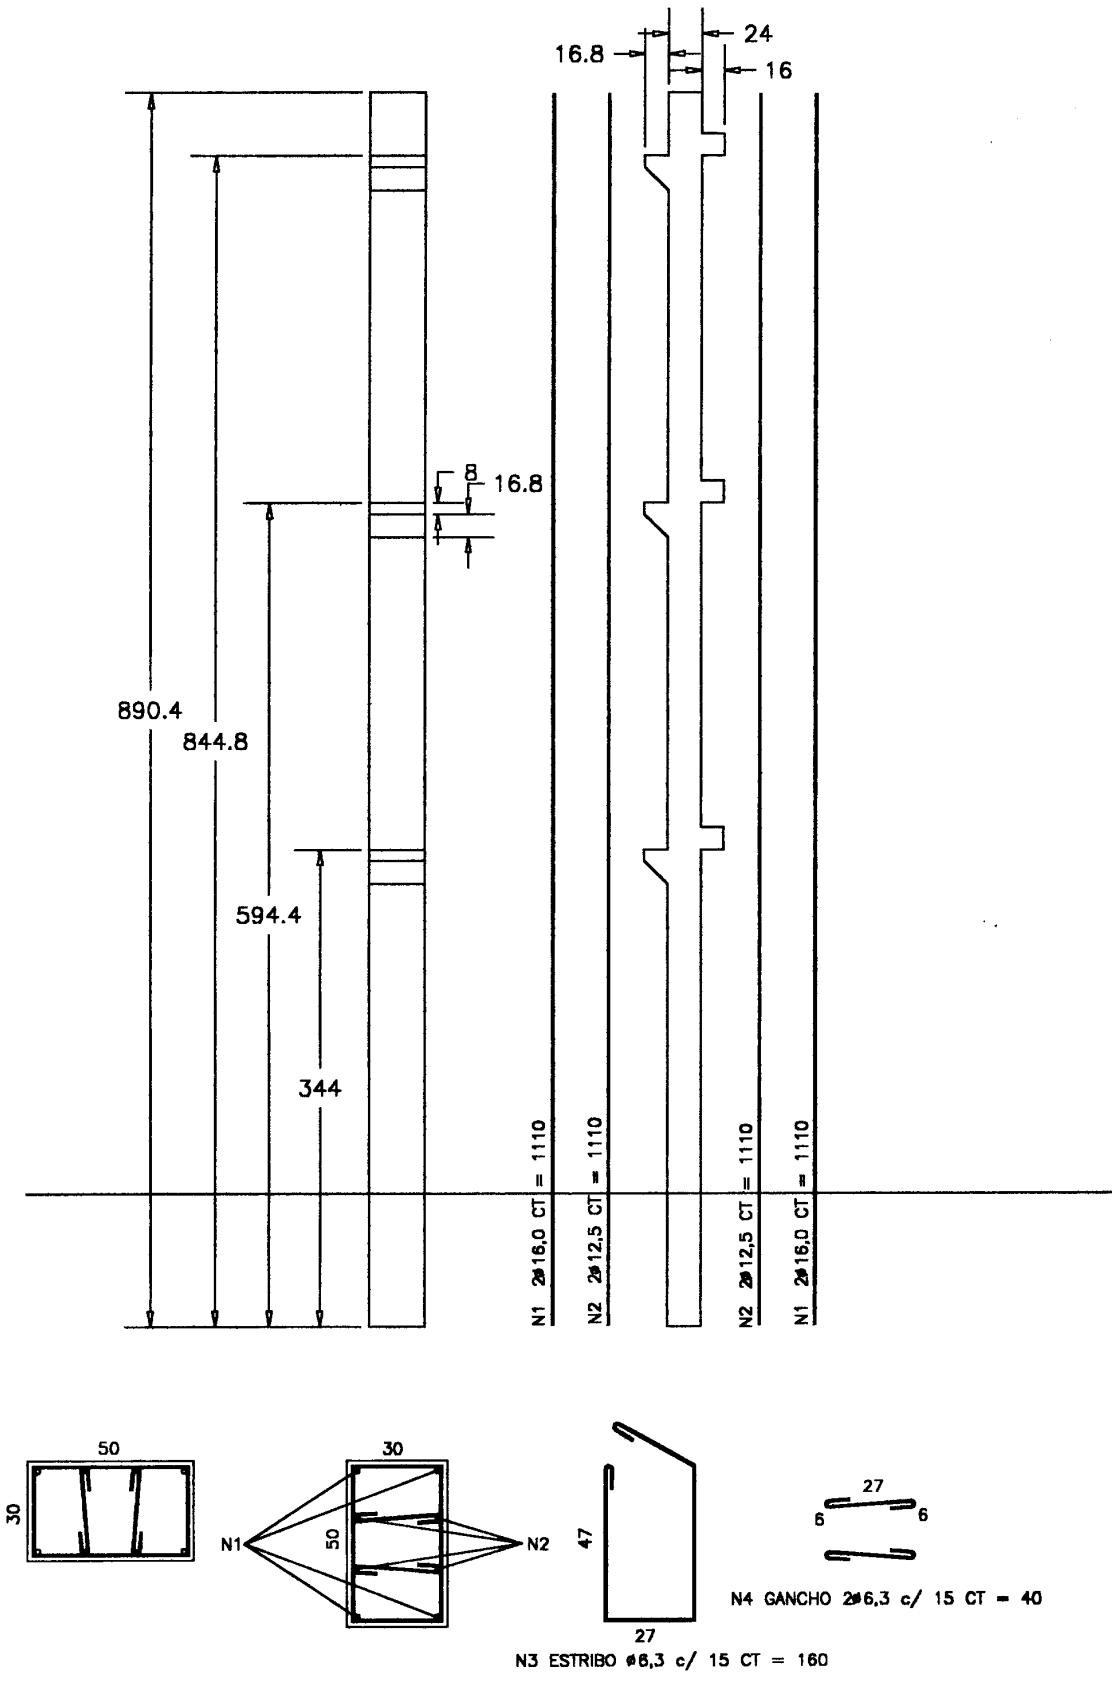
Detalhamento de Armadura do Pilar P7
